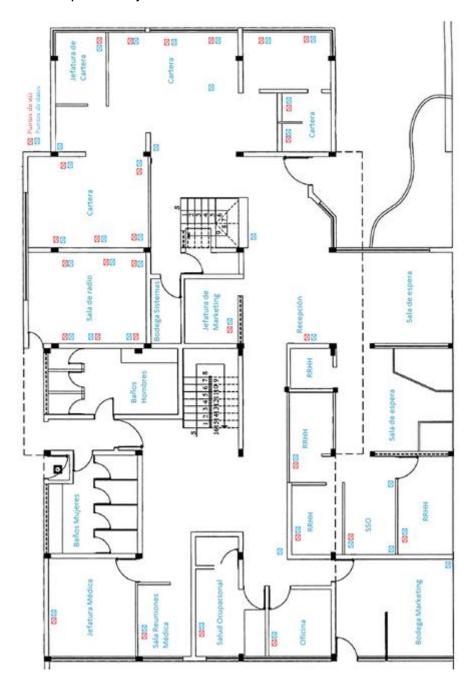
Planos Red Pasiva, puntos voz y datos Planta Baja.
